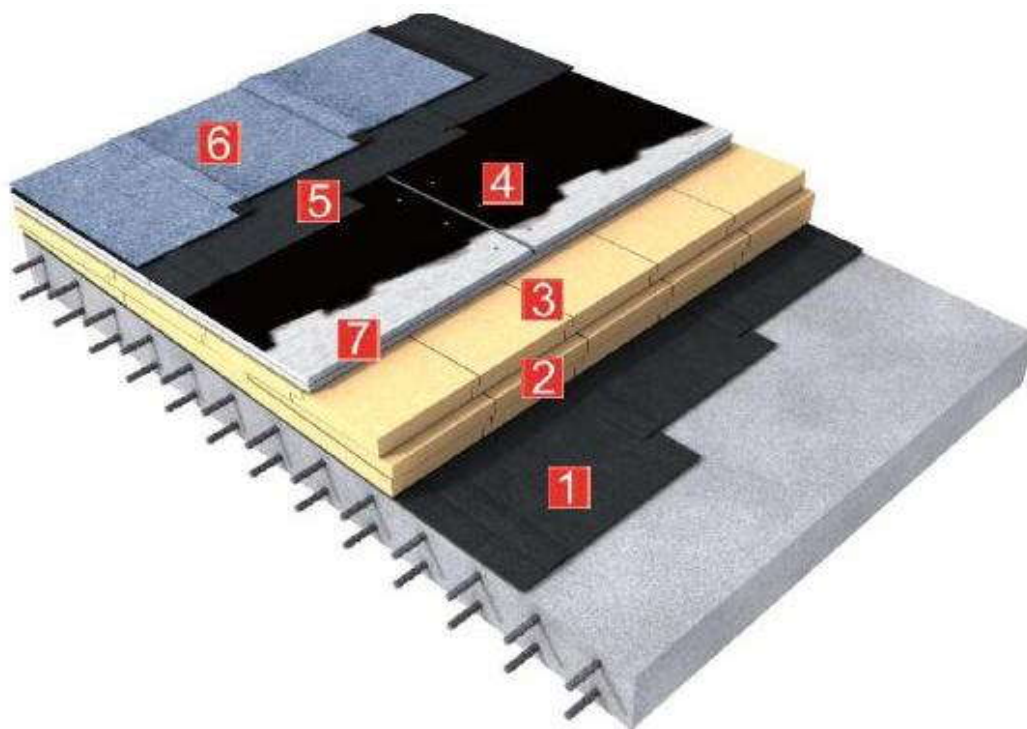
Кровля ТН-КРОВЛЯ Универсал
